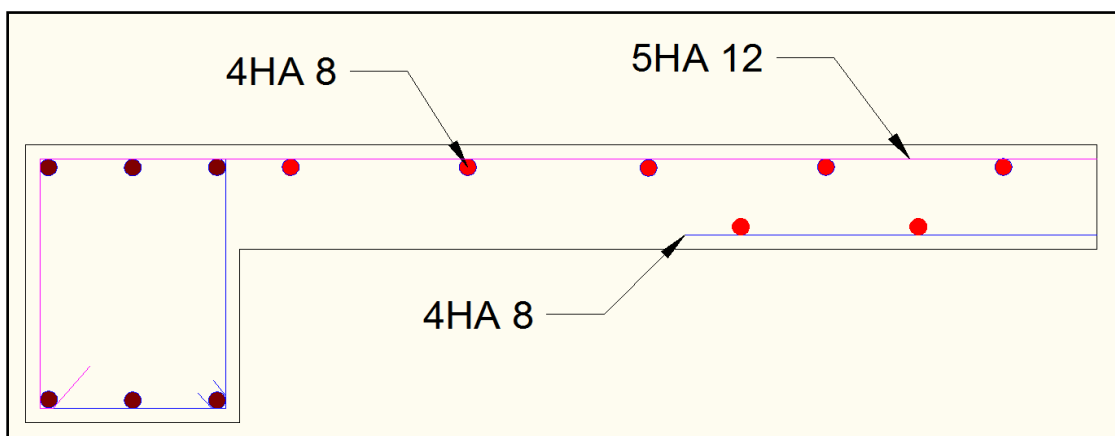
Schéma de ferrailage de la volée intermédiaire de l'escalier type 3.
